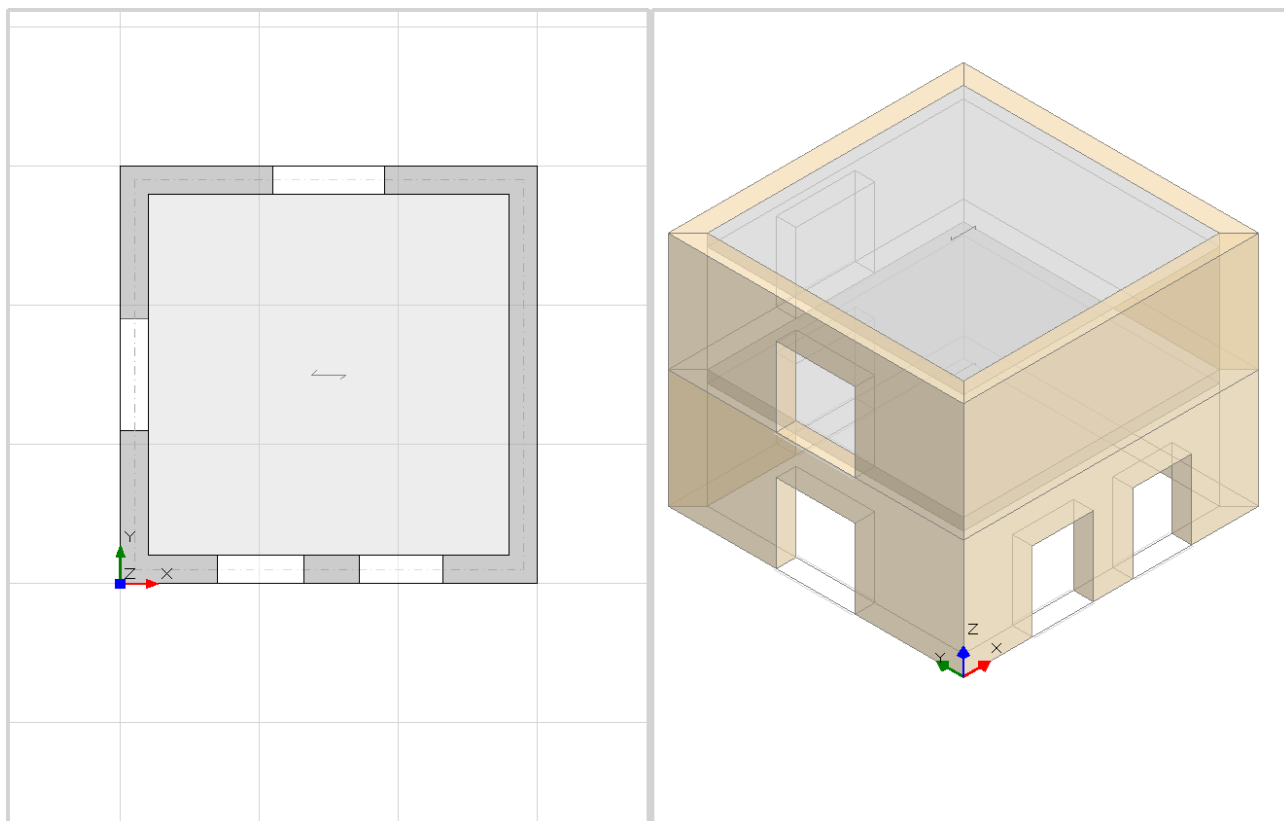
Edificio oggetto di studio: Pianta del Piano Terra e Vista assonometrica da Sud-Ovest
